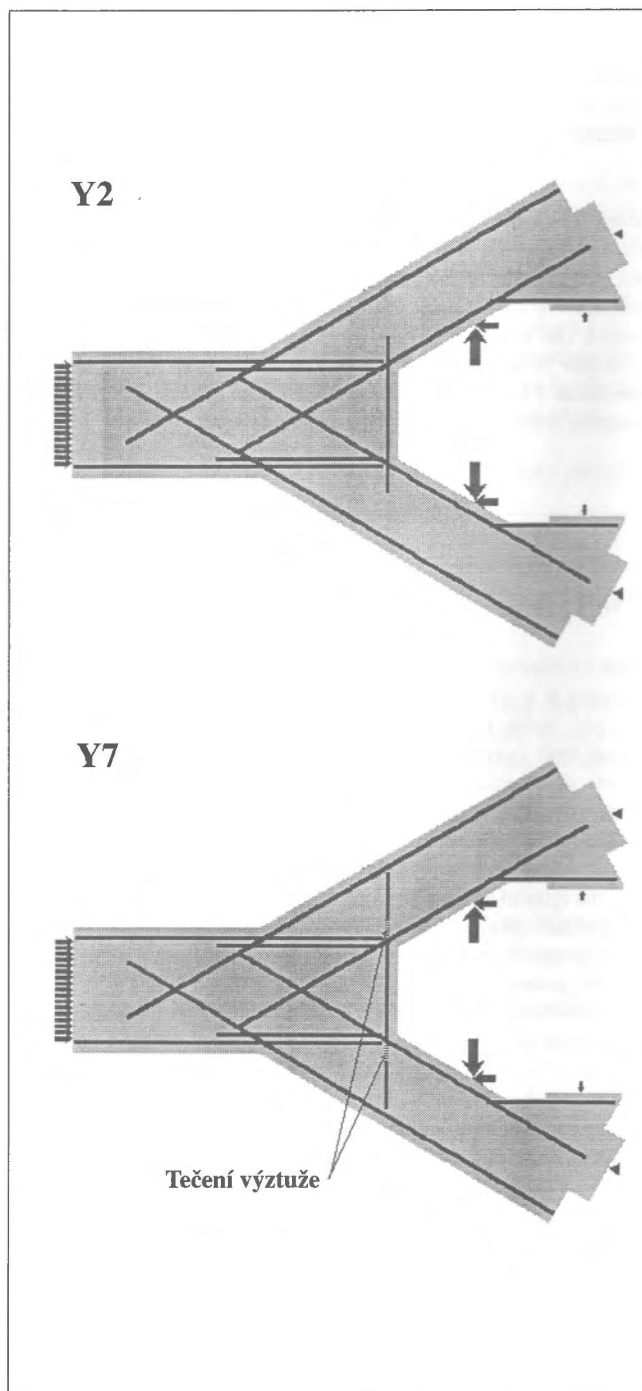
Způsoby porušení vyšetřovaného detailu pro případy Y2 a Y7 – obrazy trhlin a místa s drceným betonem / Failure modes of the cases Y2 and Y7 – crack patterns with concrete crushing
